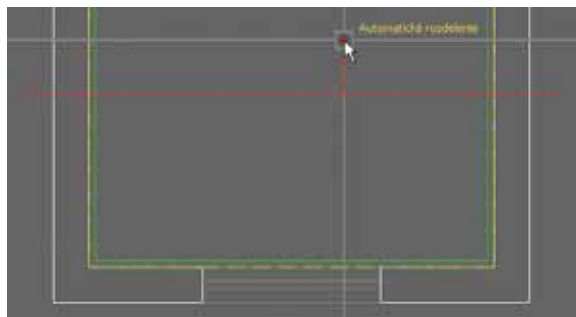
, Obr. 2.4-17 Ukážky spojitkej dilatácie
